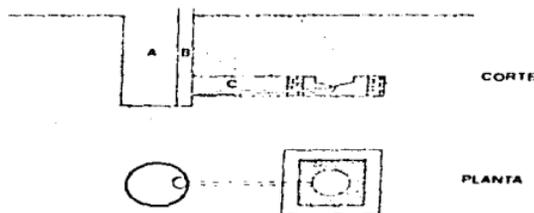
Lisímetro subterráneo de DIENERT. A) pozo; B) Tubo colector vertical, y C) Galería de 2.50 m de altura por 1 m de ancho.
